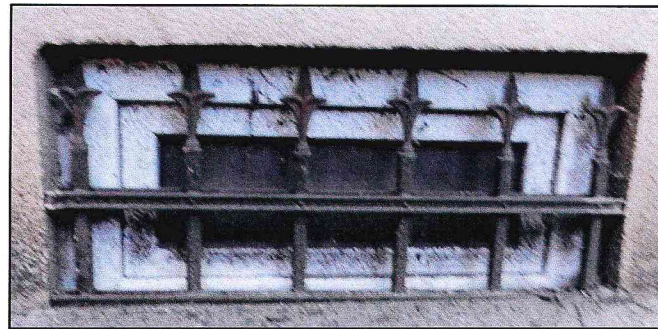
Оконные проемы на фасадах № 1, 2,3,4 в уровне подвала.
